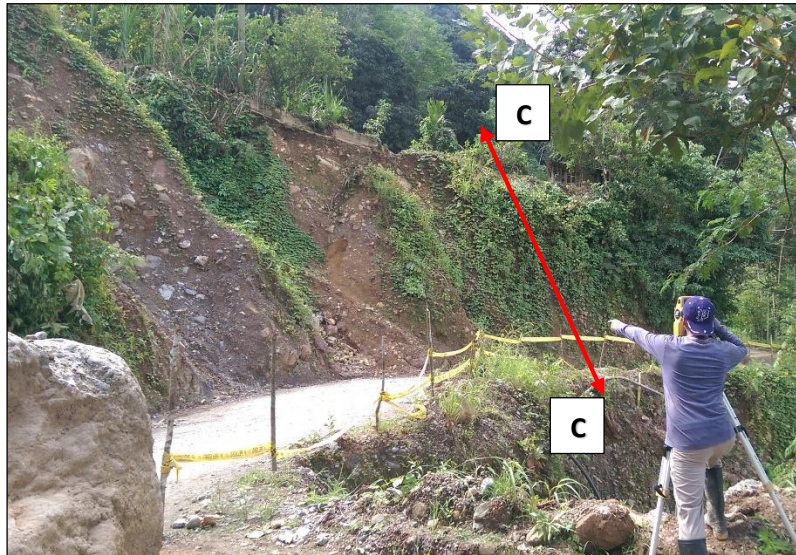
Sección C-C, que aún no ha colapsado (más estable).
